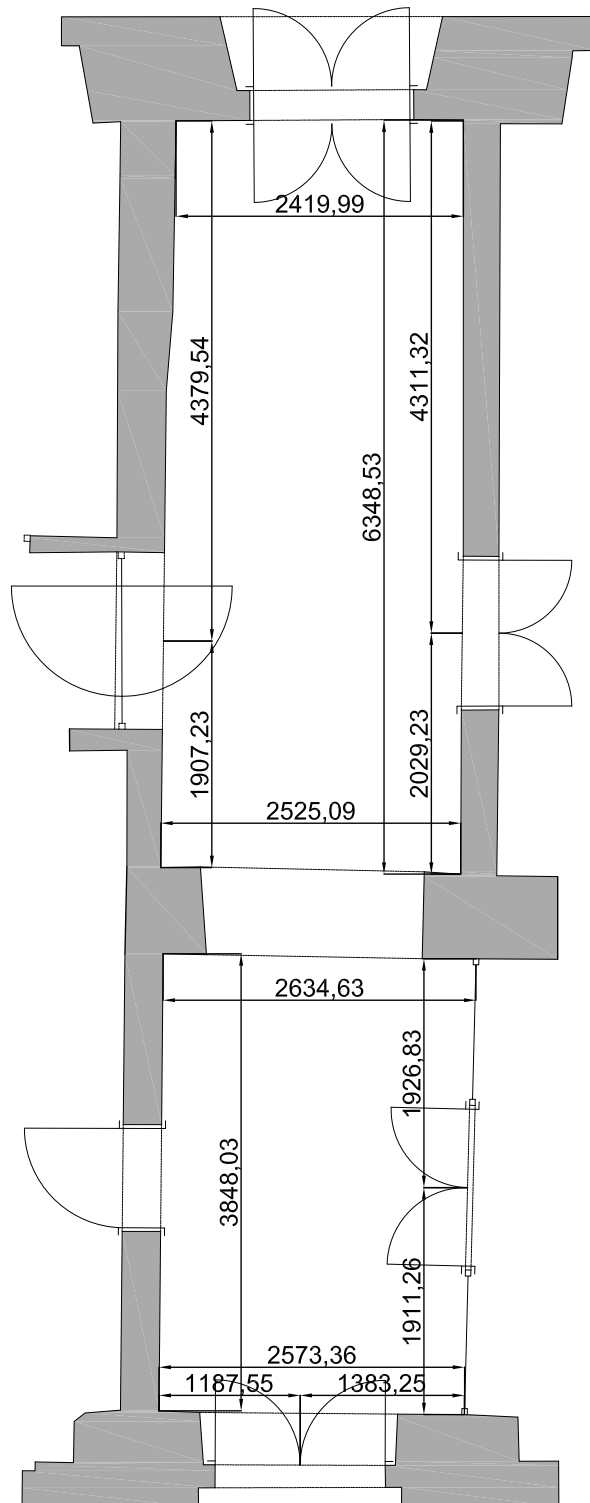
Grundriss vom Foyer und Empfang
